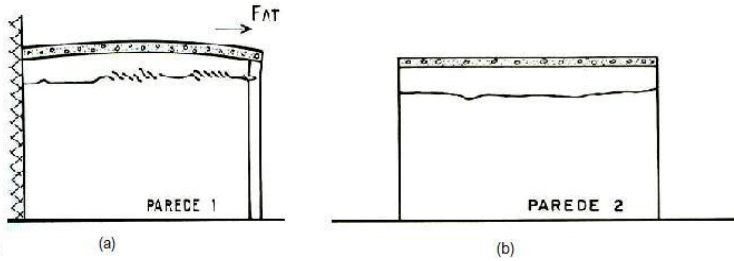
Fissura horizontal em paredes causada pela dilatação da laje de cobertura
